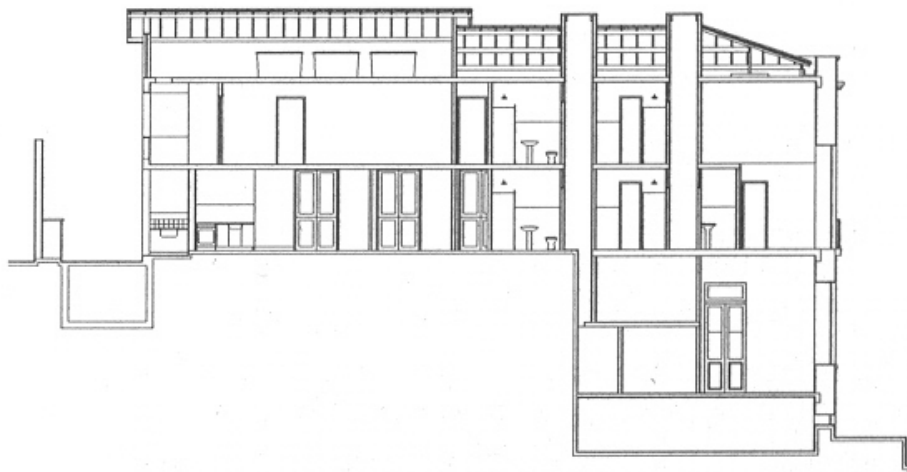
Corte longitudinal da edificação à rua Francisco Muratori, 38. Observar a subdivisão do pé-direito em três pavimentos (SECRETARIA, 2000, p. 74).
